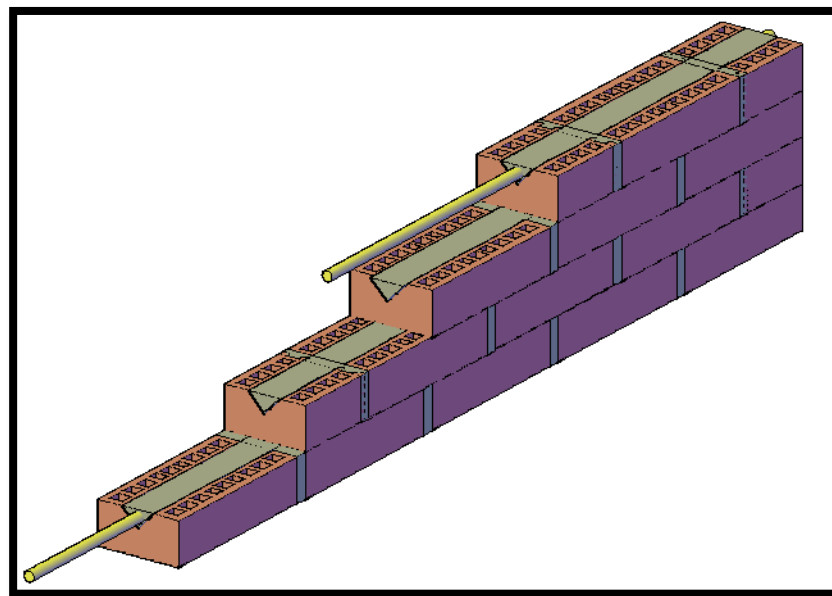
Bosquejo muro de albañilería sin tendel con armadura fi 8 como escalera
